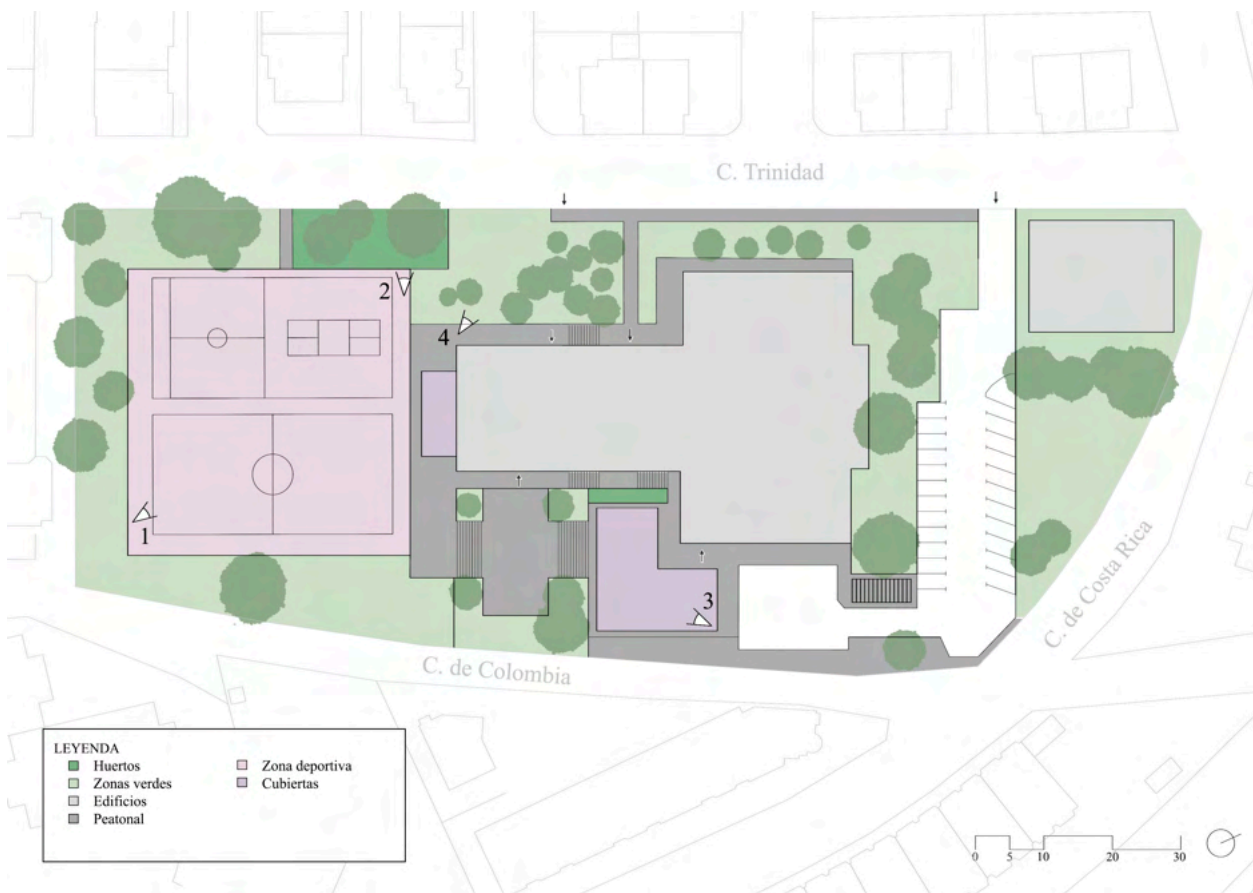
Plano del exterior de la Fundación Manantial, Fuenlabrada.
